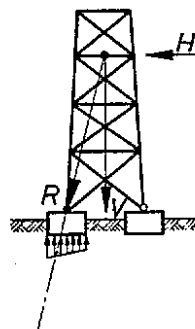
Kippempfindliches Bauwerk auf kippstabilen Flächengründung
